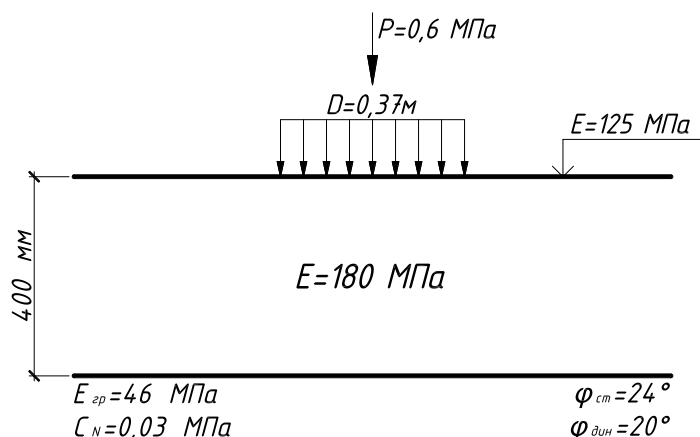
Расчетная схема проектируемой дорожной одежды.
